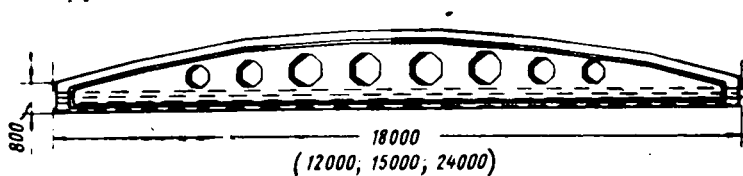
Предварительно напряженные балки с верхней полкой криволинейного очертания и натяжением арматуры на бетон
